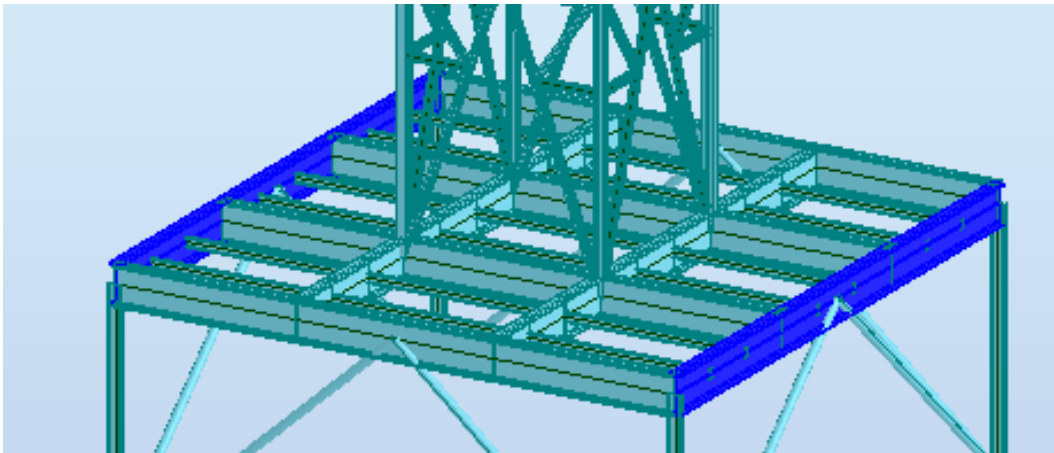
Barras das vigas exteriores da estrutura metálica de suporte (plano Y-Z)
